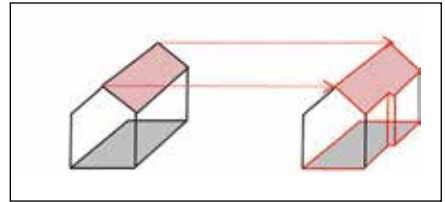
Geändertes Gebäude: Übertragen der Dachflächen auf den geänderten Grundriss
